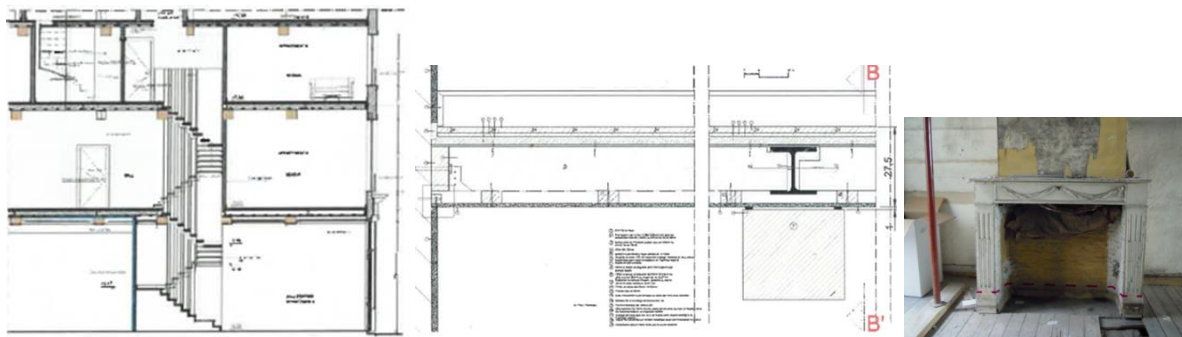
Surélévation du plancher et modification des allèges des fenêtres (niveau existant - niveau projeté)
